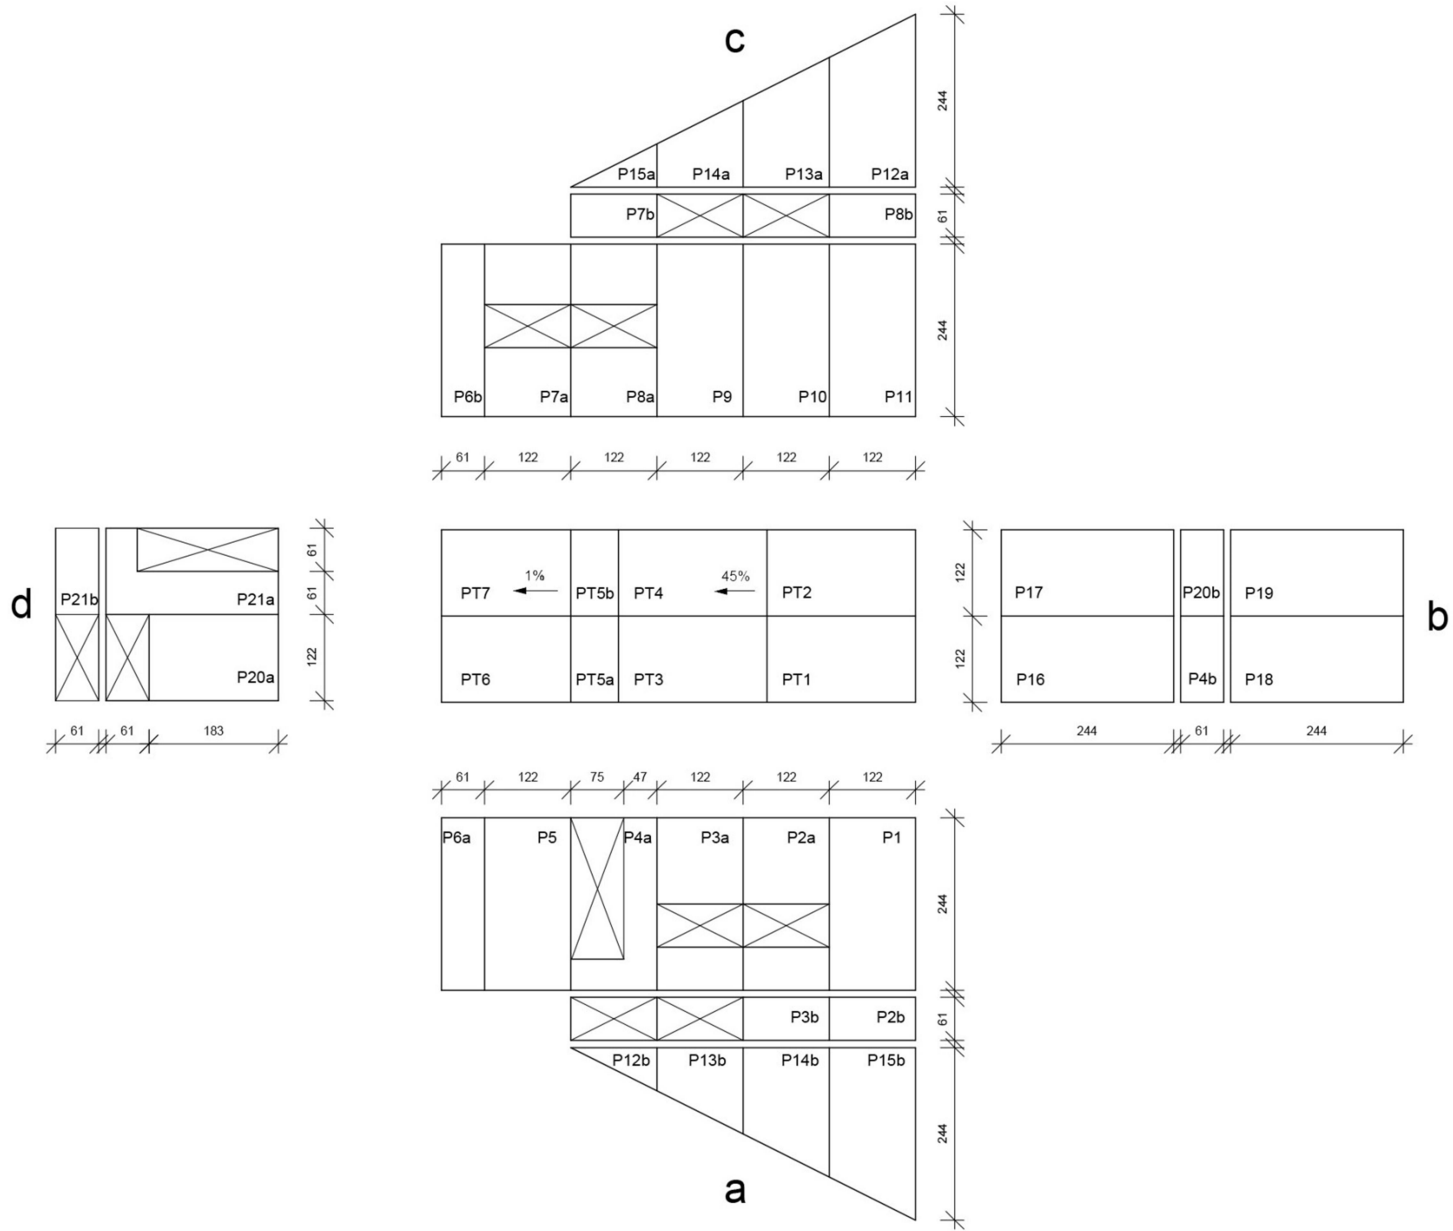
Esquema explicativo utilización paneles muros perimetrales: Vista superior vivienda, despiece en planta con medidas s/e.
